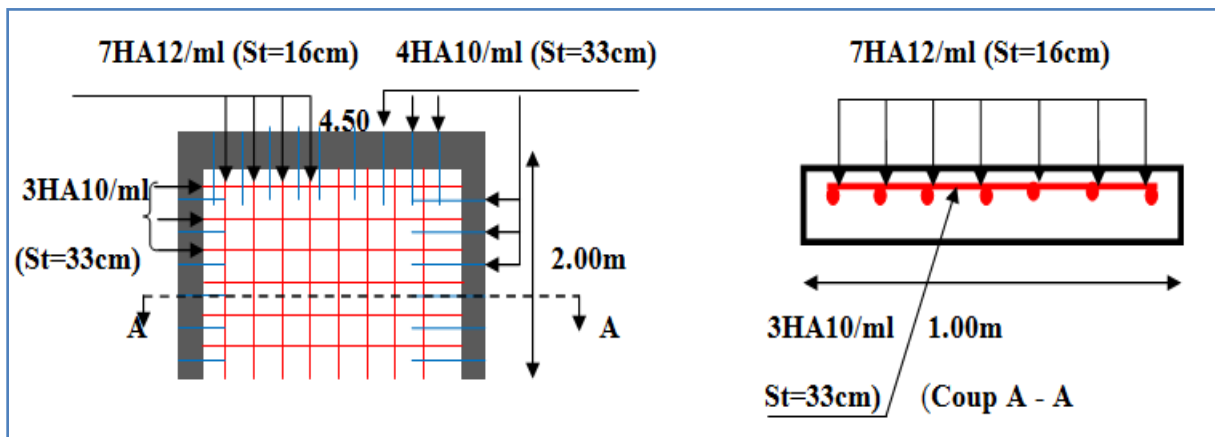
Schéma de ferrailage de la dalle sur trois appuis
